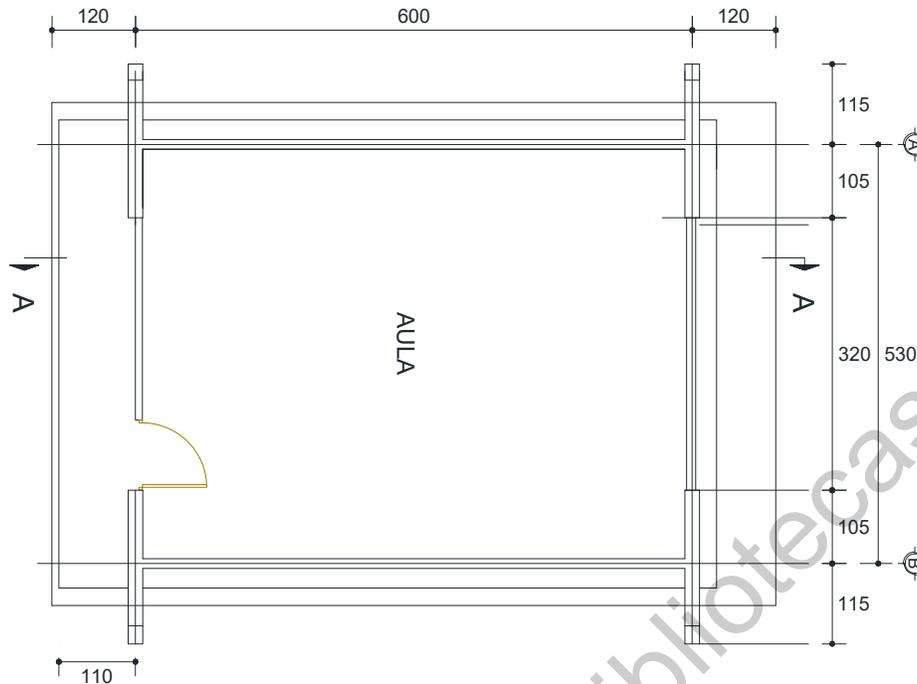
Planta Arquitectónica salón INIFED (ALVAREZ, 2014)
